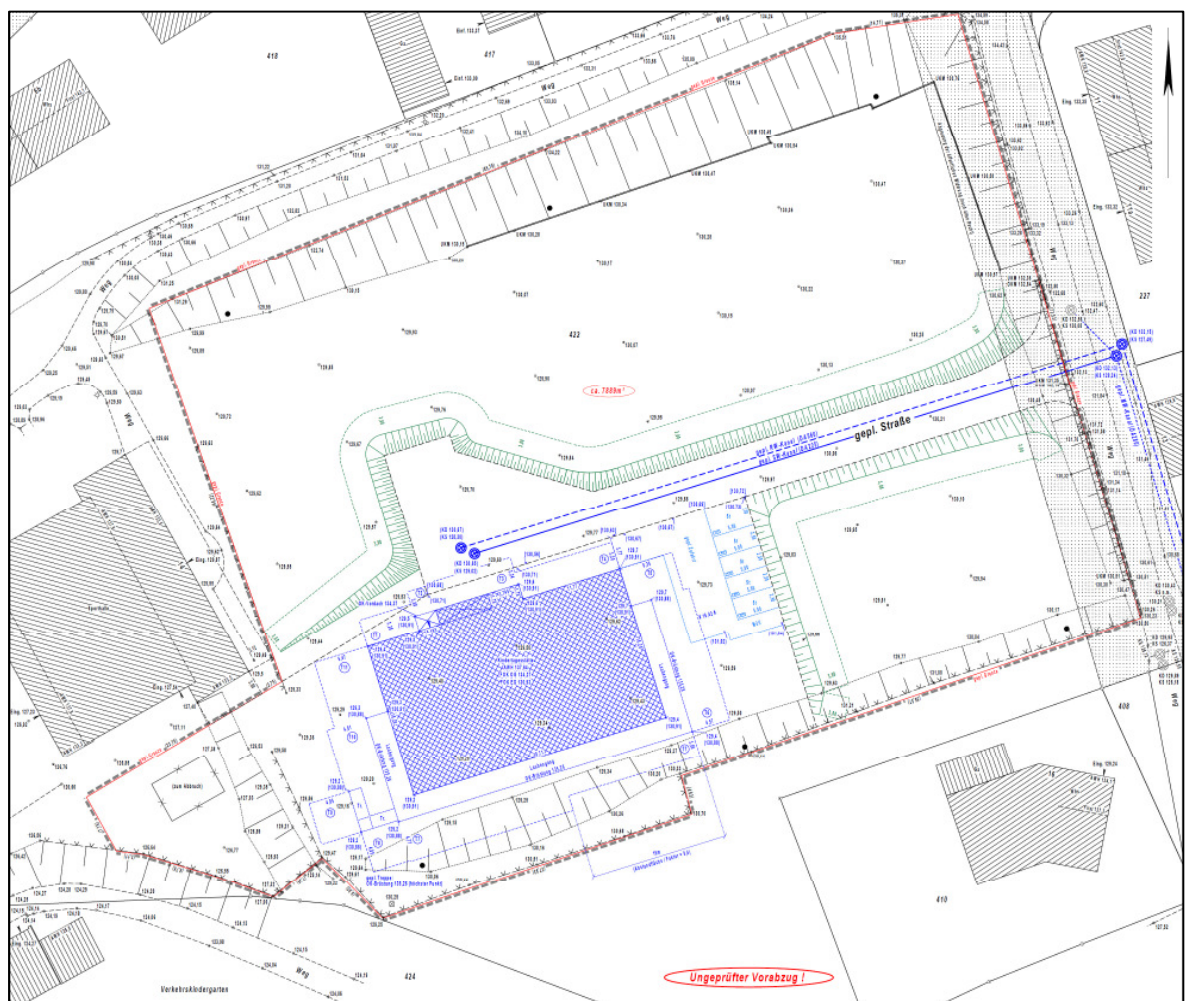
Amtlicher Lageplan zum Bauantrag (Vorentwurf) [1]
